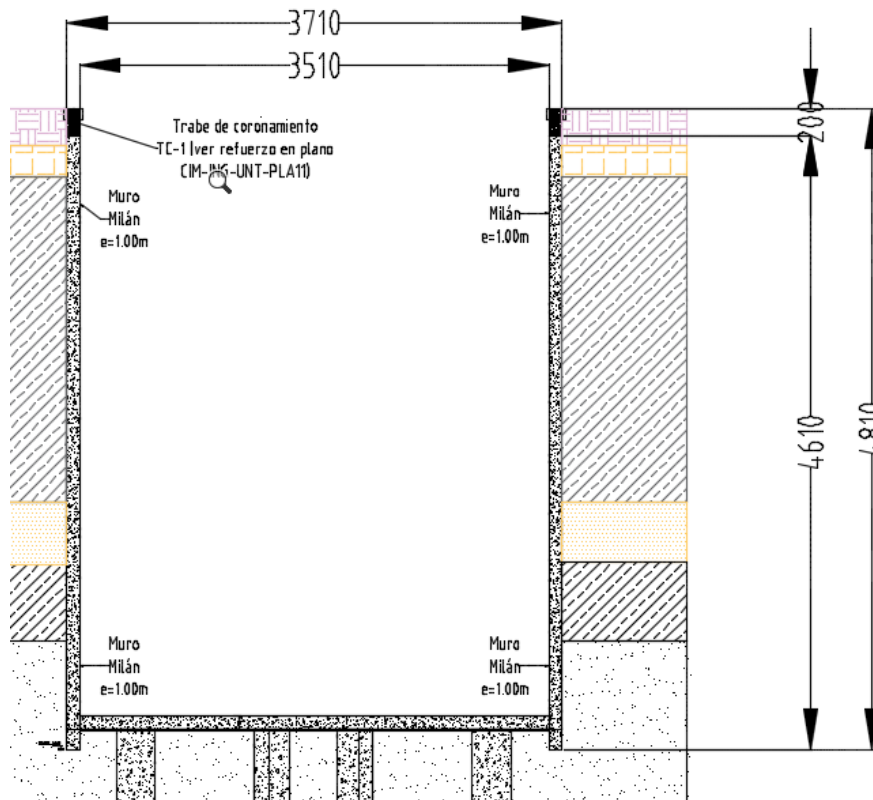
Dimensiones de la subestructura. Corte Transversal A-A⁴⁹
